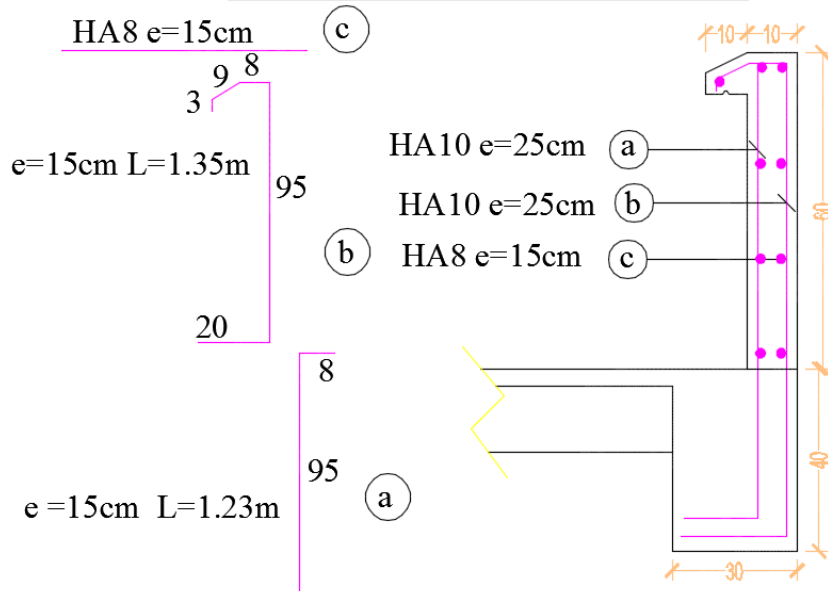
Schéma de Ferrailage de l'acrotère.
